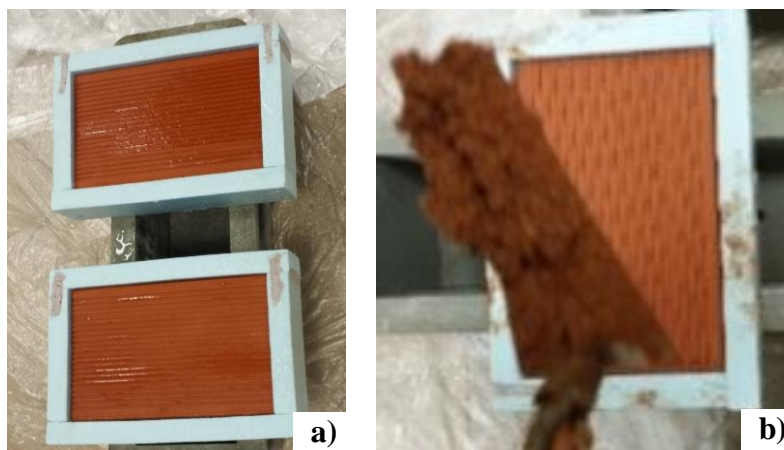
Aplicação da massa no suporte: a) Colocação dos moldes em poliestireno extrudido e humedecimento dos tijolos; b) Aplicação da argamassa no tijolo em queda livre.
